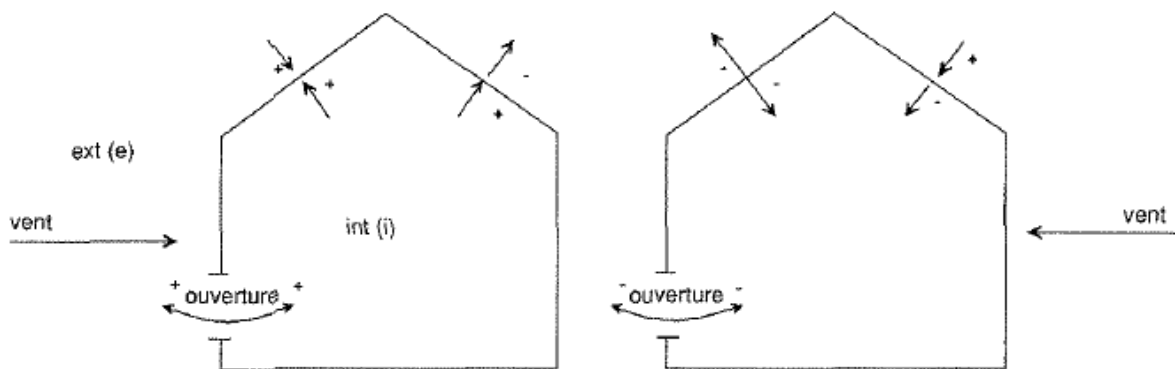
Pression du vent sur les versants d'une toiture (- : dépression, + : surpression).
